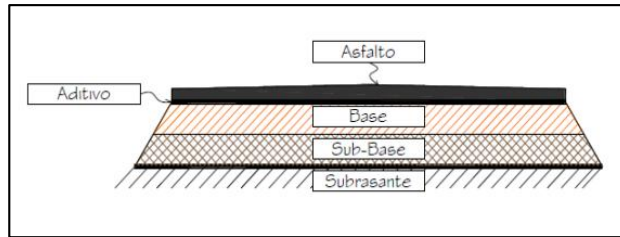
Sección Típica Transversal Pavimento Semirrígido
